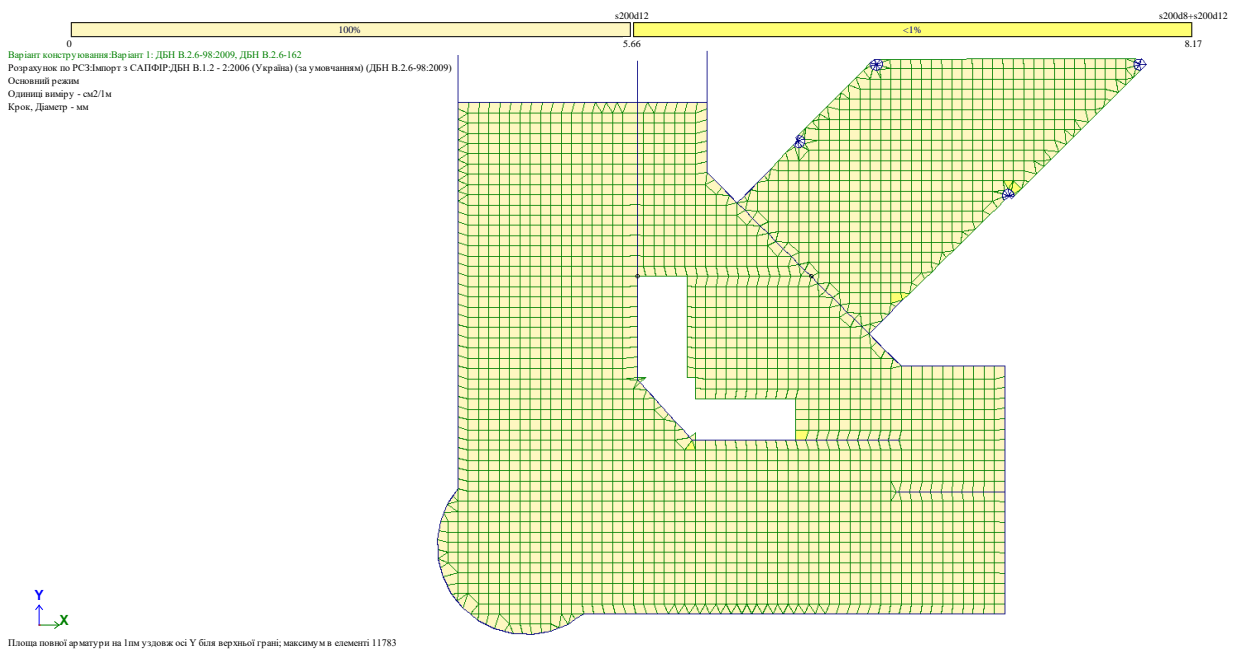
Площа повної арматури на 1м уздовж осі Y біля верхньої грані для плити перекриття 1-го поверху
